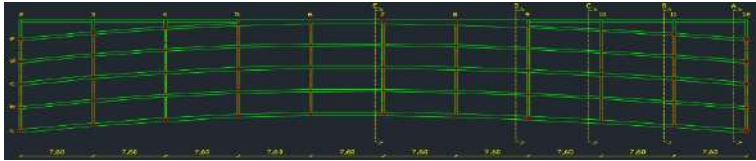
Pianta dell'arco del Viadotto Olivieri
